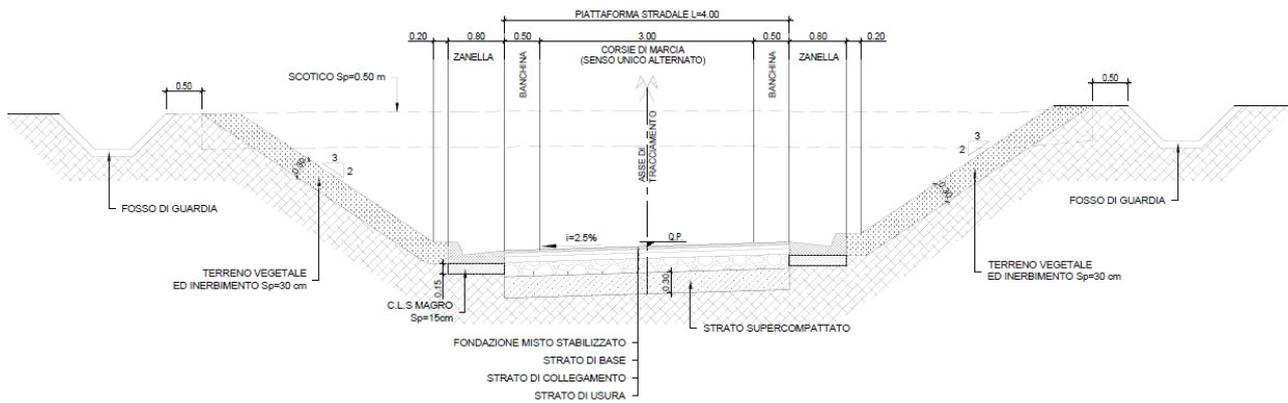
Dest. Particolare 4.0 m - sezione tipo in trincea
